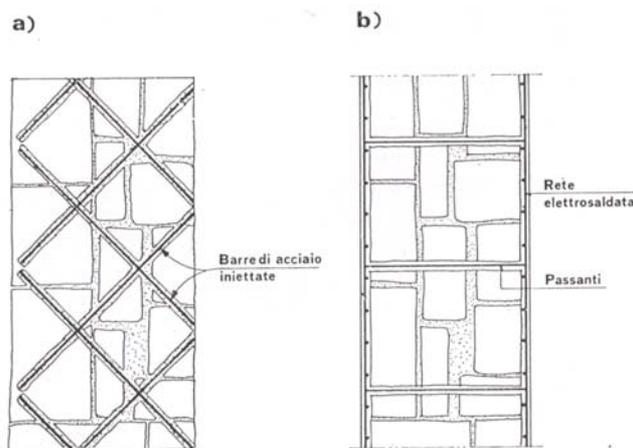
Consolidamento di strutture murarie: a) con iniezioni armate; b) con intonaci cementizi retinati.
